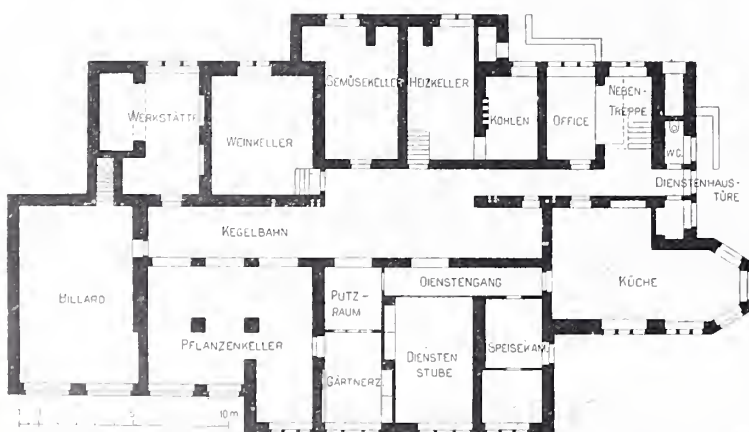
und 4. Grundrisse vom Untergeschoss und Erdgeschoss. — Masstab 1 : 400.
